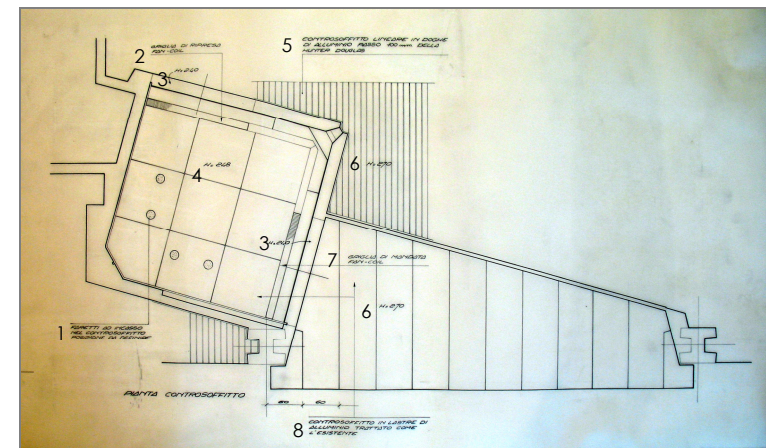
proposta di ristrutturazione generale – nuova sistemazione bussola ingresso piano primo – PIANTA CONTROSOFFITTO (fonte CSAC , stralcio tav. 71, archivio n. 371-1, rielaborazione f.m.)
